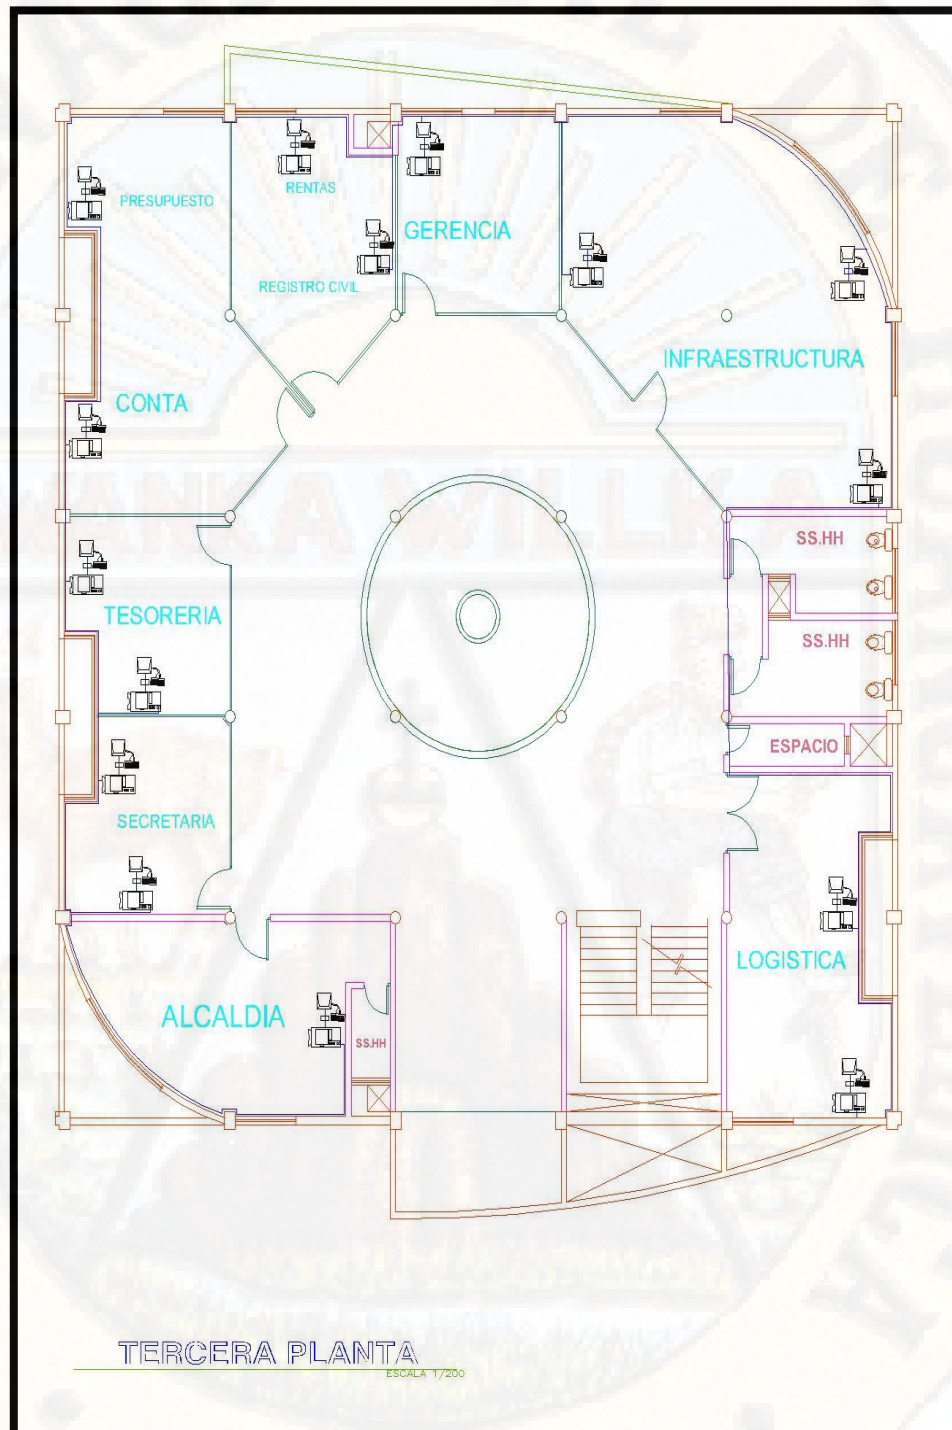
Plano de ubicación de la Tercera planta del edificio de la MDDH
